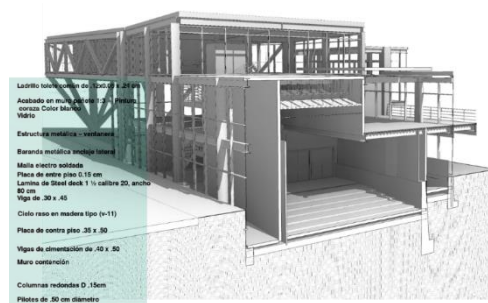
Corte fachada. Fuente: elaboración propia. 2018.
